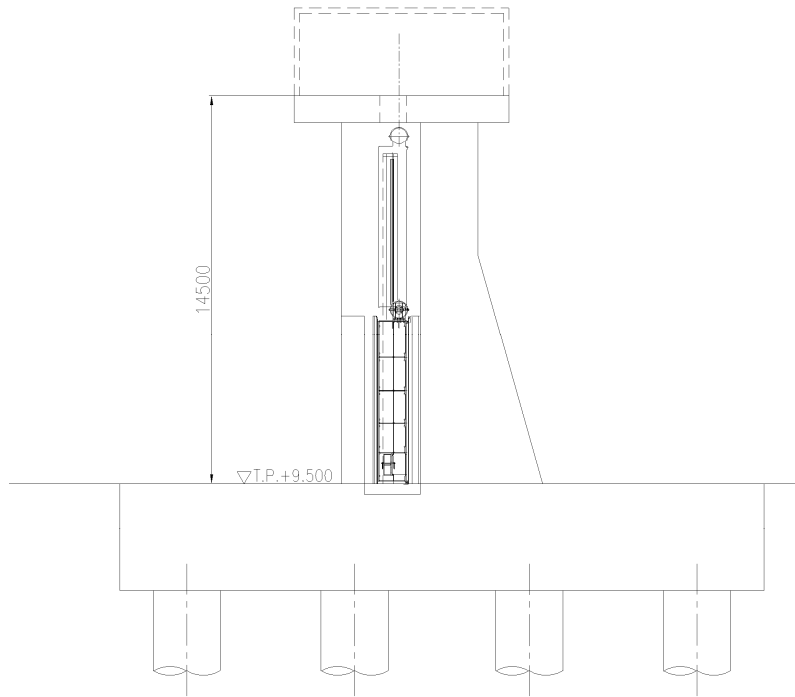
鉄筋コンクリート防潮壁断面図 (防潮扉 2)
